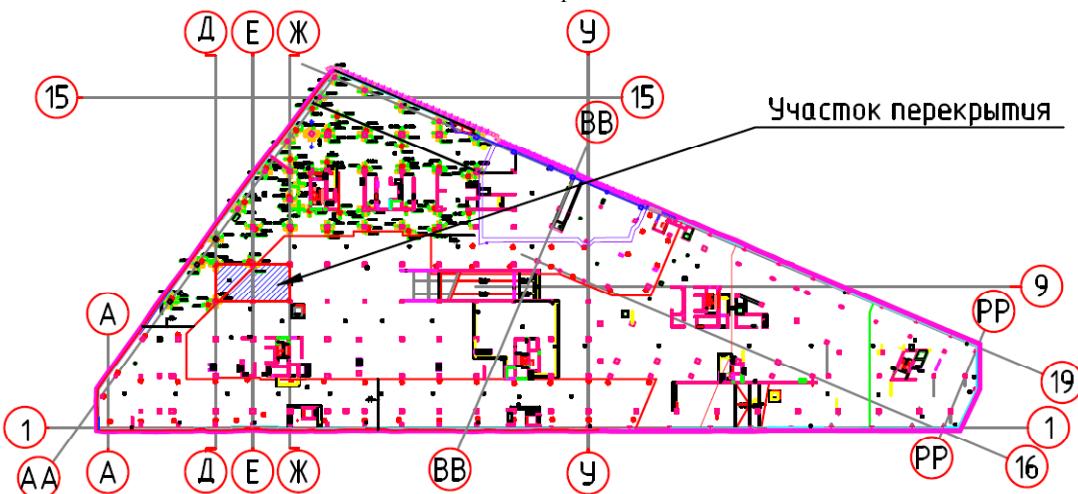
Схема расположения участка усиливаемого перекрытия в габарите осей «8-10/Д-Ж» на отм. -4.350
